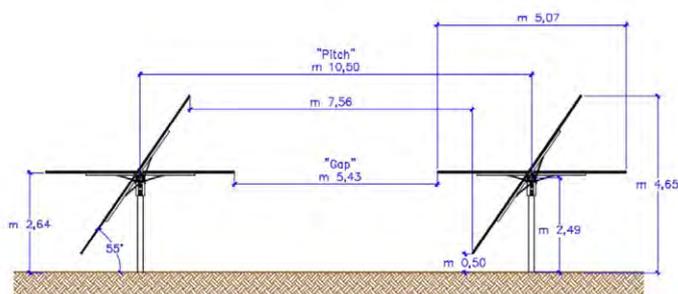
Sezione dell'area dell'impianto con indicazione delle scelte progettuali
